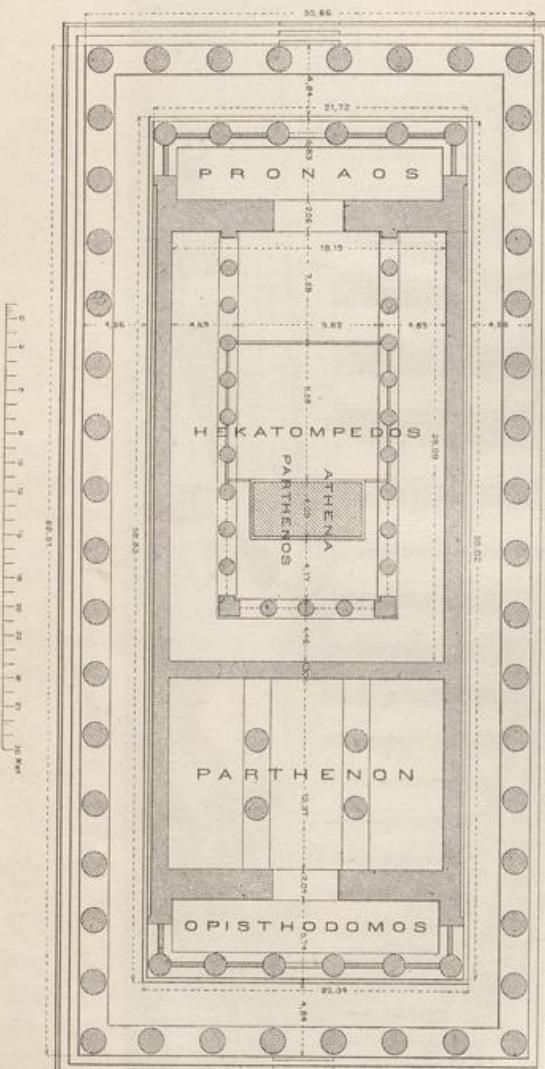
Grundriss des Parthenon. (Nach Treu.)
